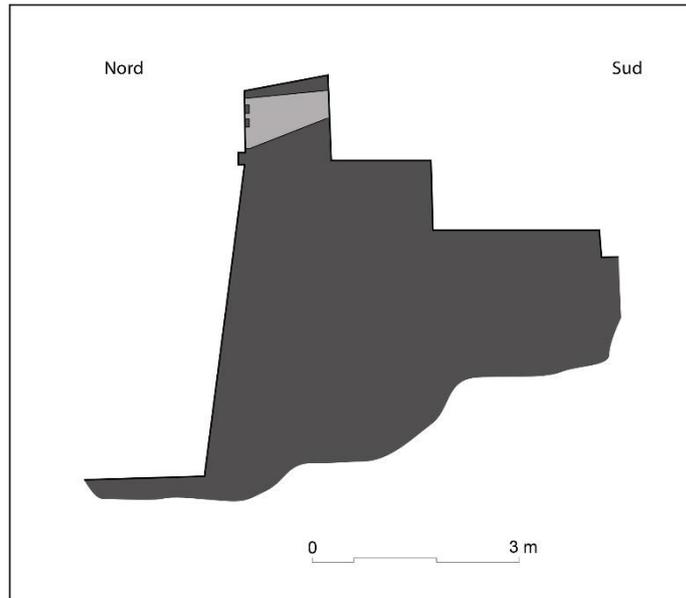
coupe du parapet de l'enceinte fortifiée sud de la citadelle (indiqué par un trait rouge sur le plan général du fort)
